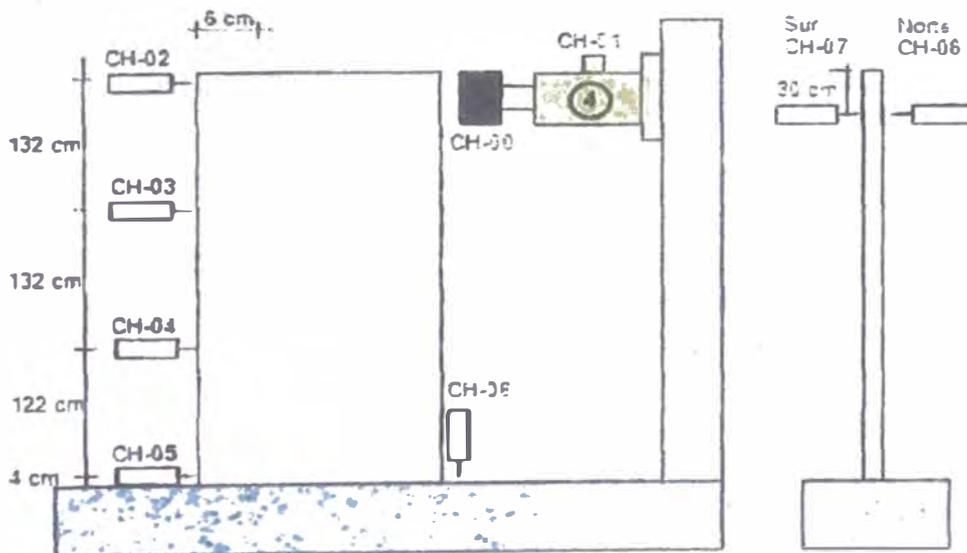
Ubicación de medidores de desplazamientos para el ensayo monotónico en panel muro TAP1180.
